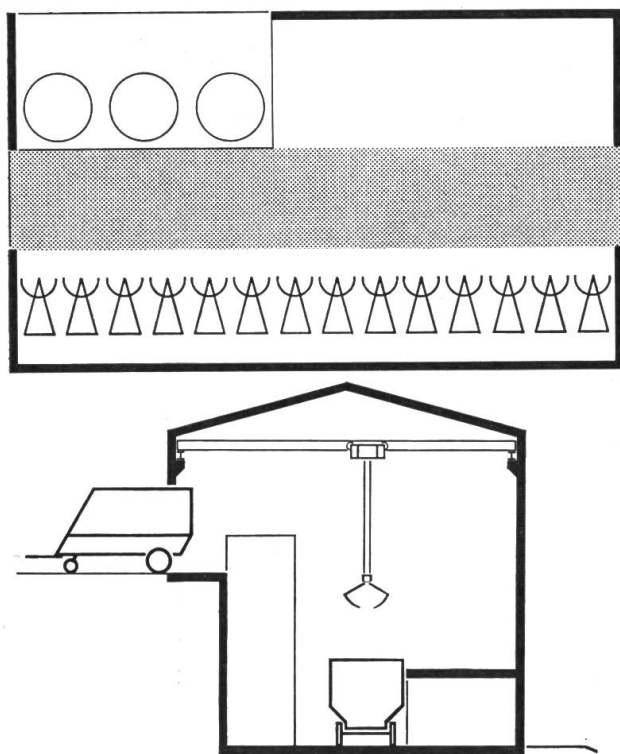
Deckenlastige Lagerung mit gemeinsamer Futter- und Erntedurchfahrt, Hanglage.
